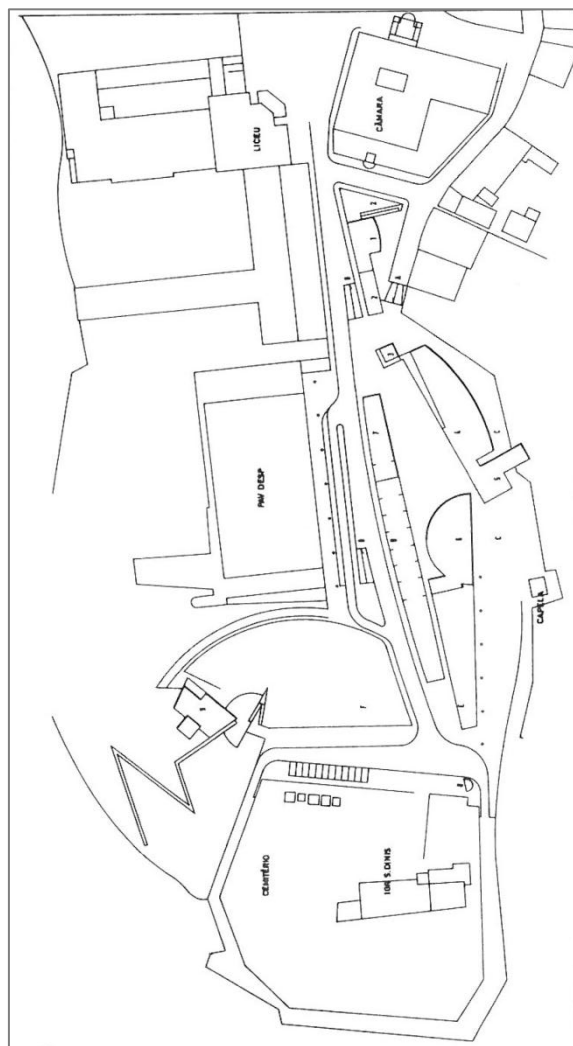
Planta de Síntese do Plano de Pormenor da Vila Velha (1988)
